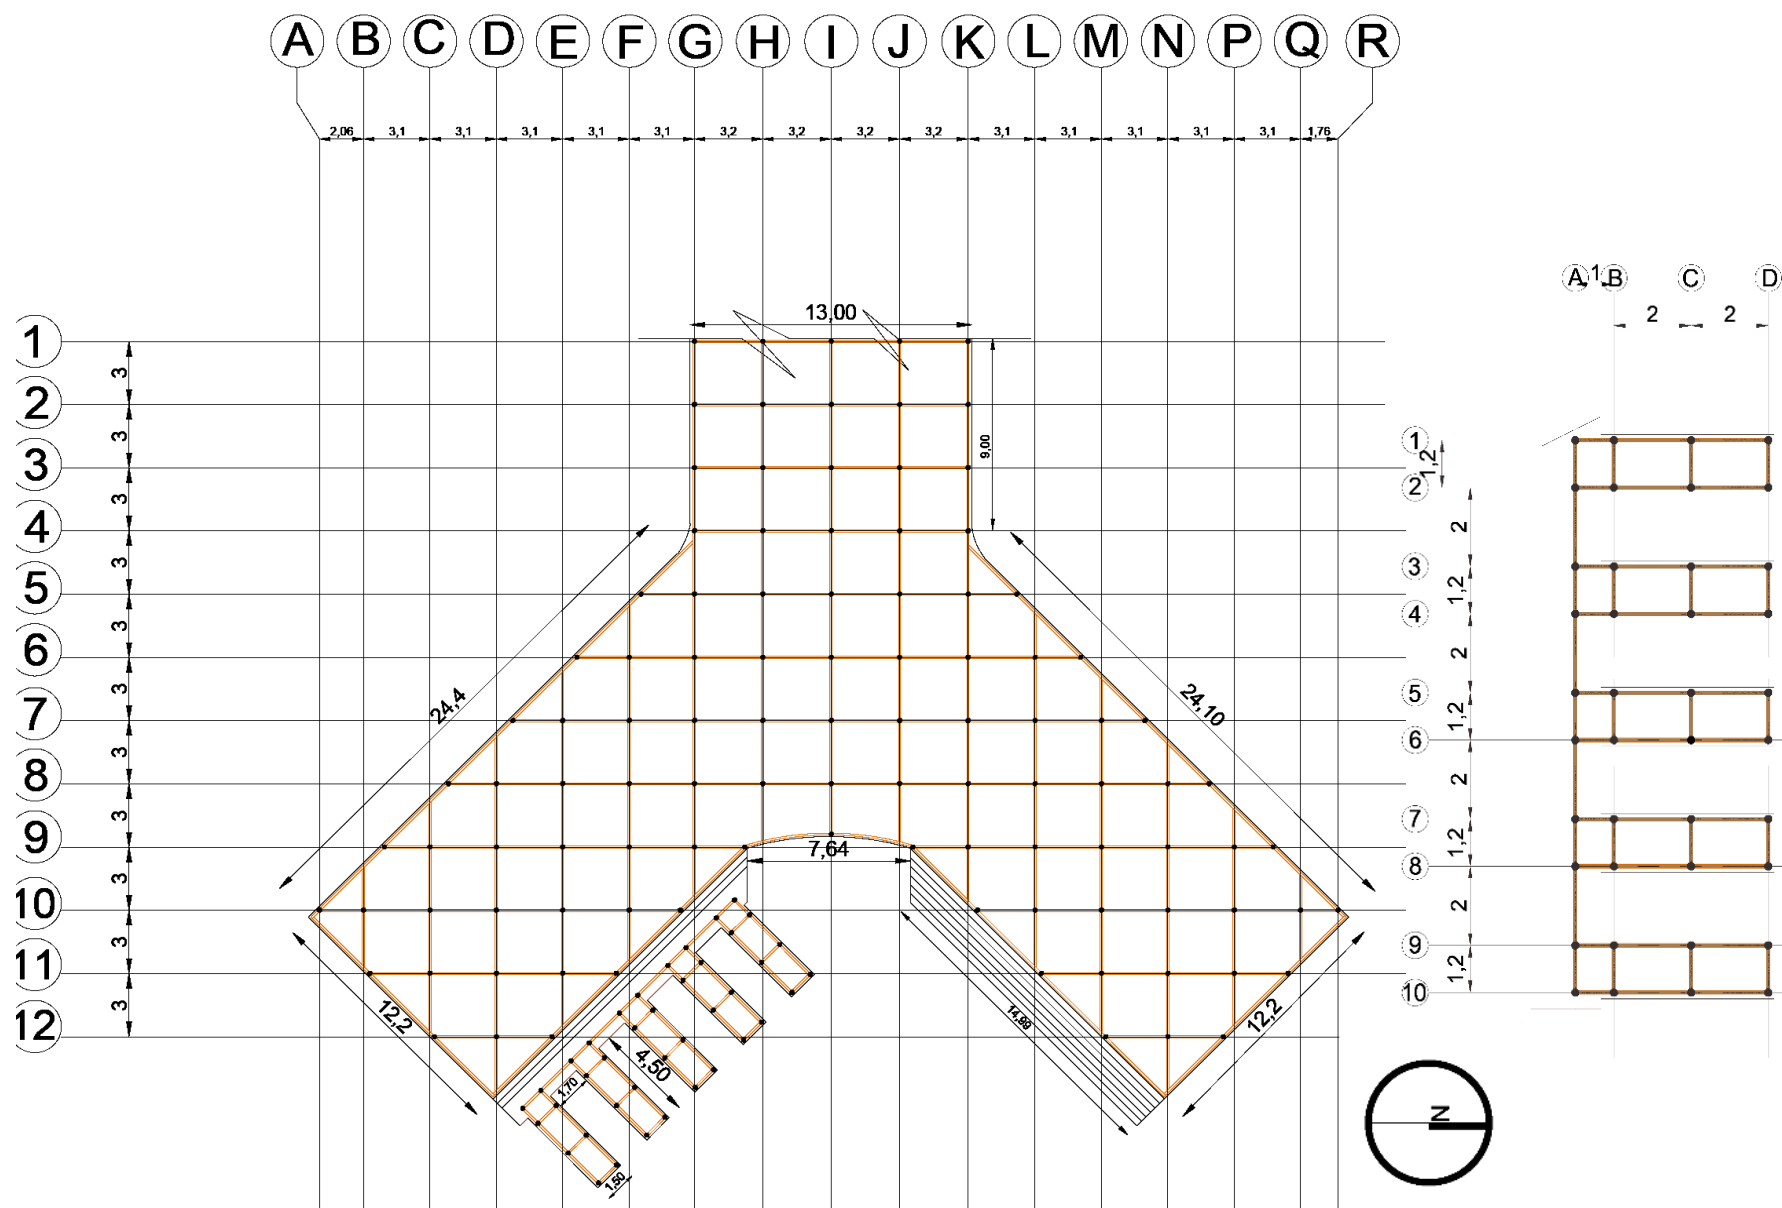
Planta estructural Plataforma 2. Fuente: Elaboración propia
